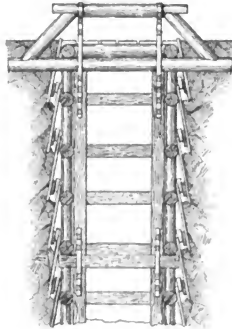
Schachtzimmerung. Bolzen-schrotzimmerung.
